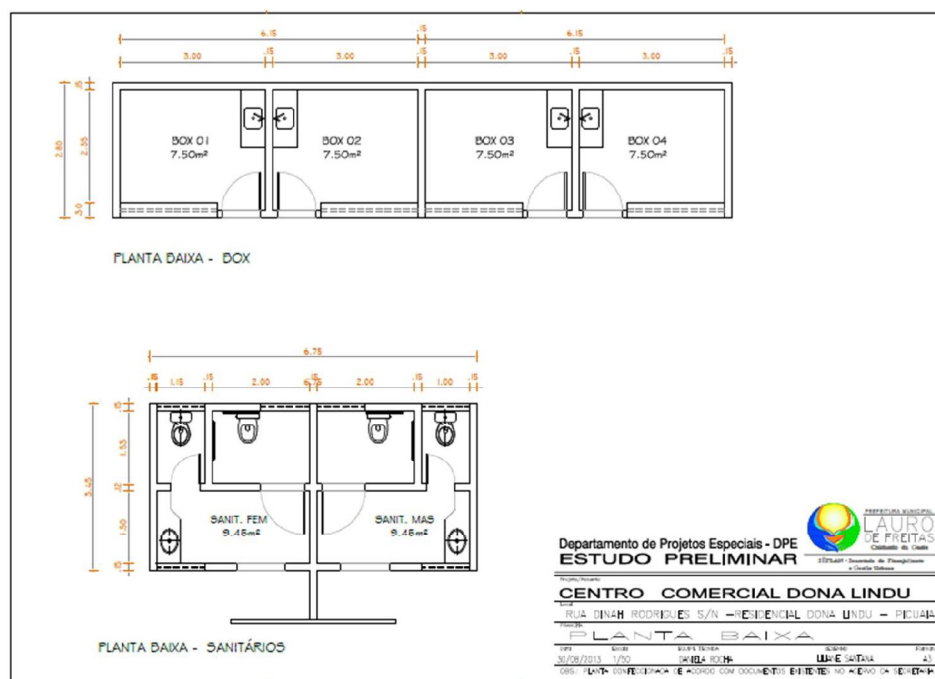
Planta baixa do Centro Comercial Dona Lindu.
